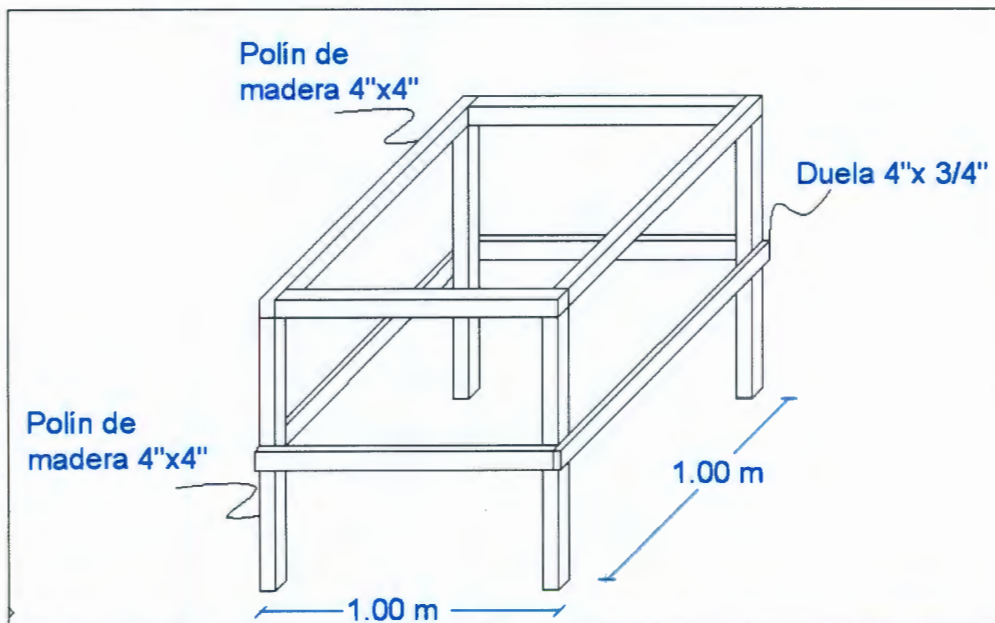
Detalle tipo para apuntalamiento de construcciones de uno o más niveles.
